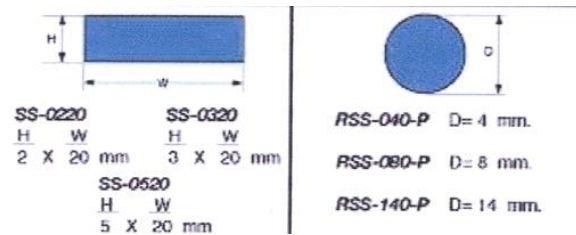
Perfis de estruturas simples em juntas de betonegum e fissuras [23]
